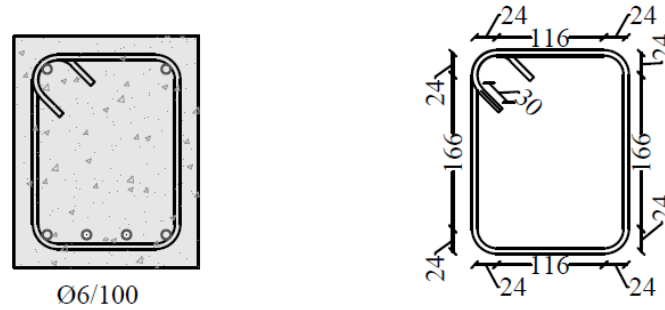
Disposición armadura de cortante de Acero. Ensayo armadura pasiva
